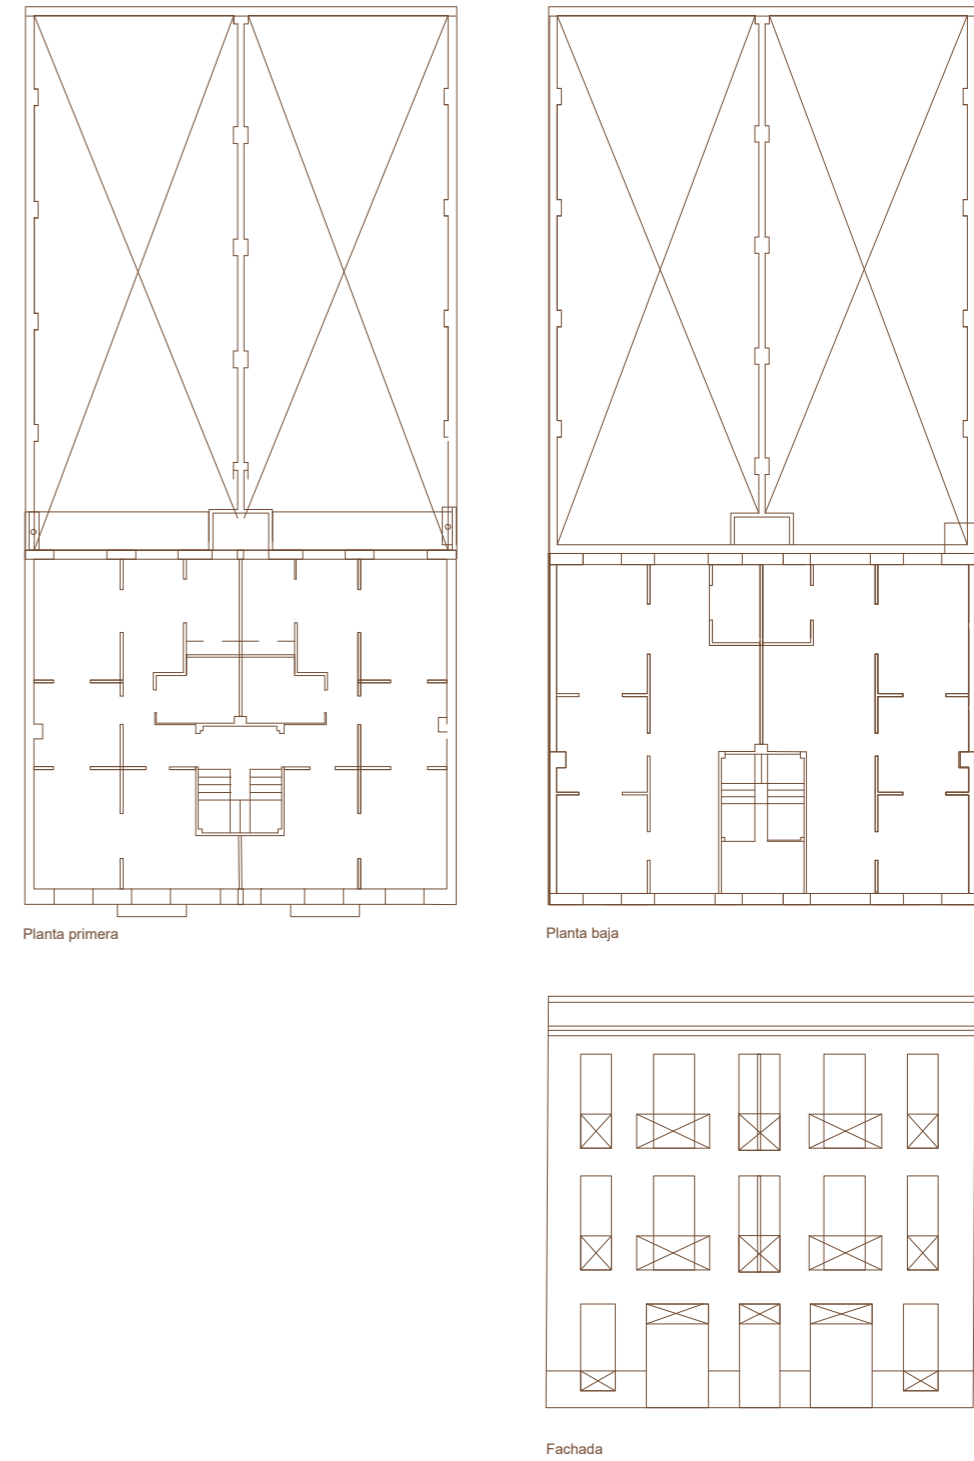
Planos edificio calle Manuel Arnau 9. Arquitecto Javier Goerlich Lleó. Elaboración propia
